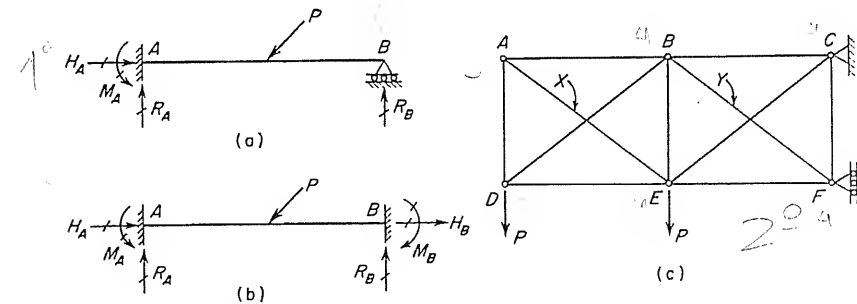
Ejemplos de estructuras estáticamente indeterminadas
